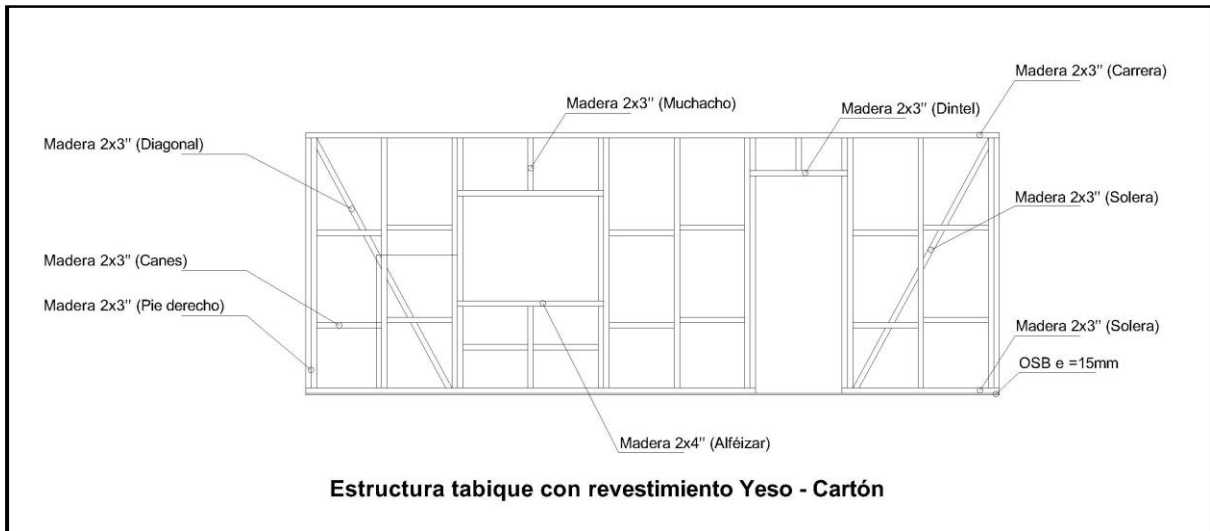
Plano detalles variados de la estructura. Elaboración propia.
